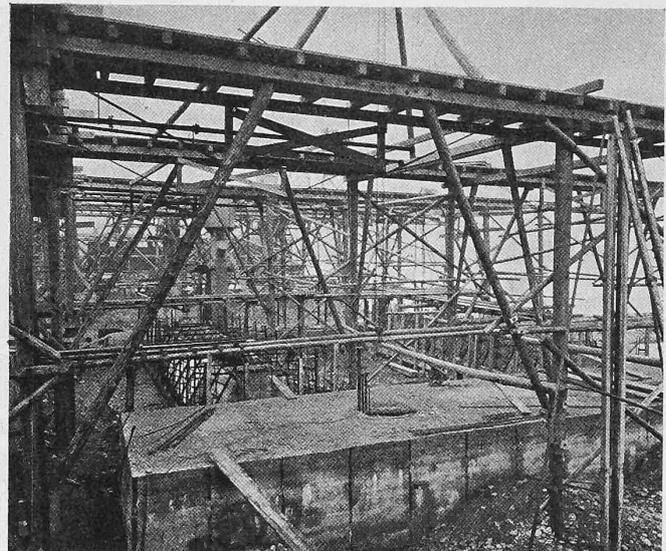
Eisenbeton-Caissons für den Landpfeiler Schweizerseite und Schwelle Nr. 1 (26. XI. 08).
